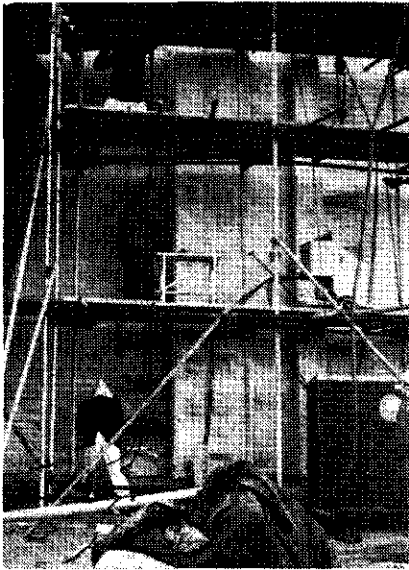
Detail wandwapening met bescherming voorspanomhullingen.
